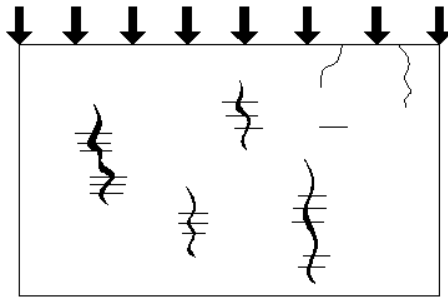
Fissuras em alvenarias causadas por sobrecarga.
